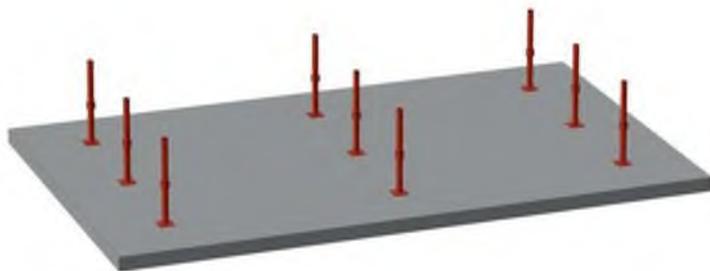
Пример опалубки перекрытий с использованием объемных стоек
